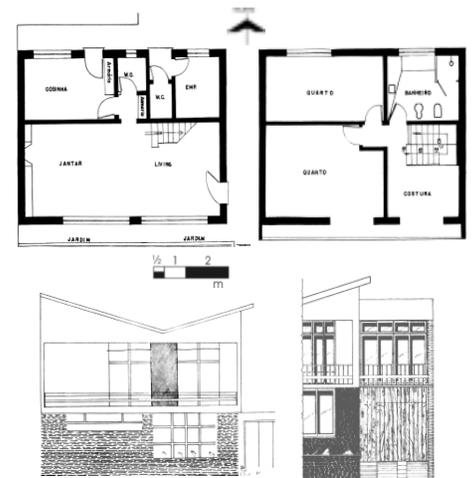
Casa Enio Pinto (1962), de Glênio Carneiro. Planta baixa térreo, superior, e fachadas.
